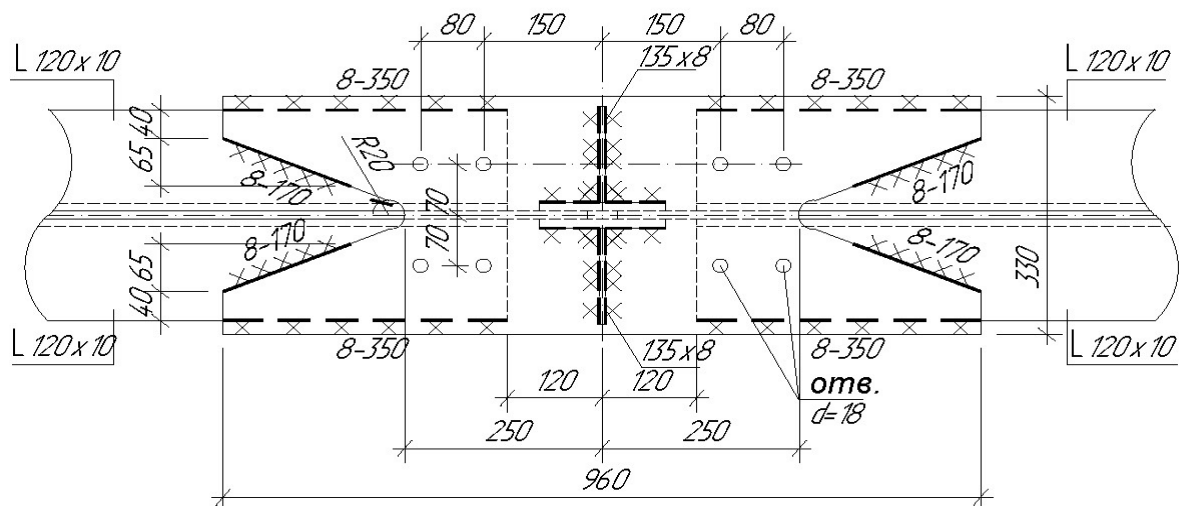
Верхний монтажный узел из парных уголков
